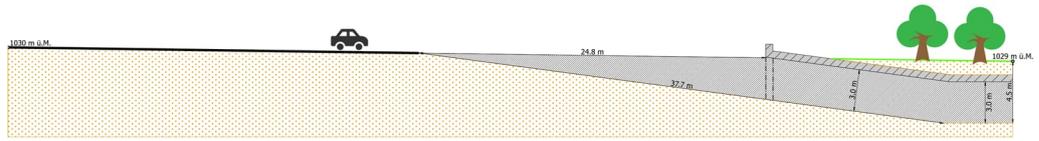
Schnitt Einfahrt Tiefgarage zu Variante 2b (massstabslos)
